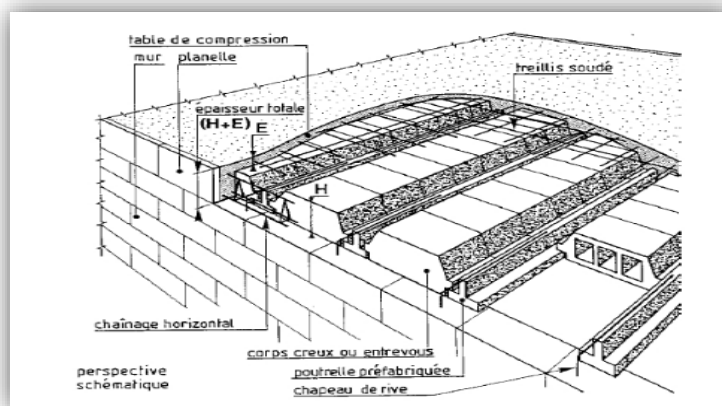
Les éléments principaux d'un plancher à corps creux.
